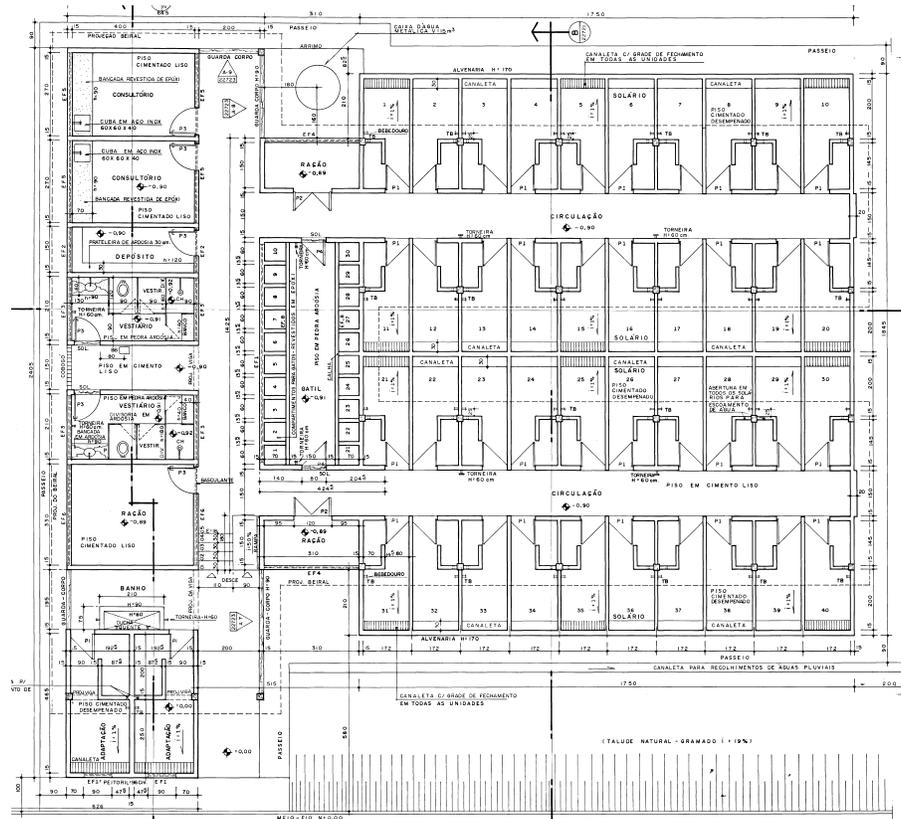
Planta Canil de Experimentação Pequenos Animais – CEPA
